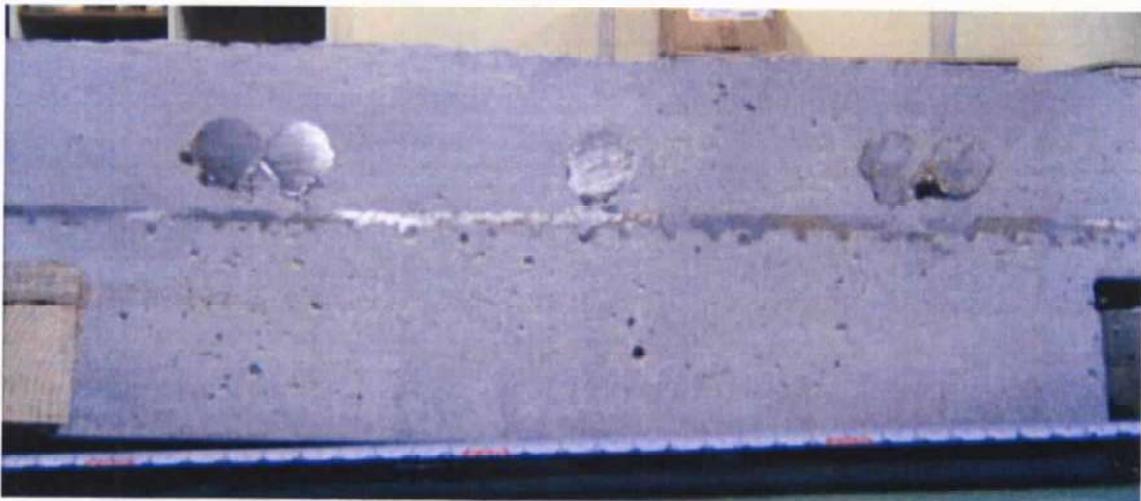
鉄筋背面への充填性試験体 (その2) の切断面
